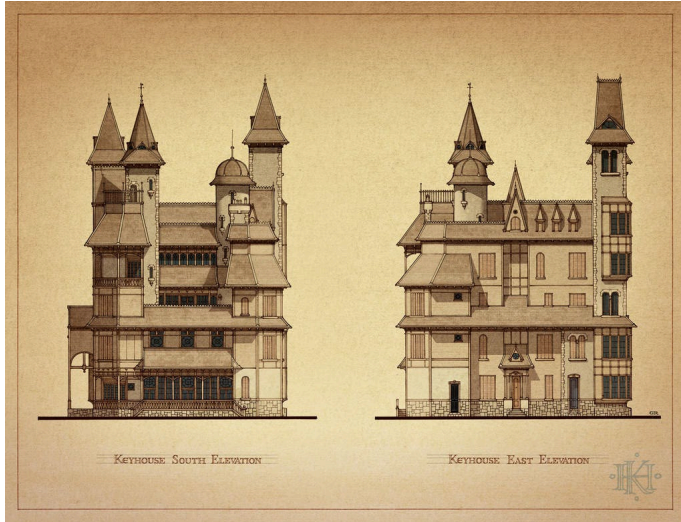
Elevaciones de la Mansión Keyhouse fuera de la historieta. Adaptado de *Keyhouse Elevations 2* [Imagen], por Gabriel Rodríguez, 2008, DeviantArt <https://www.deviantart.com/gabrielrodriguez/art/Keyhouse-Elevations-2-106027575>
